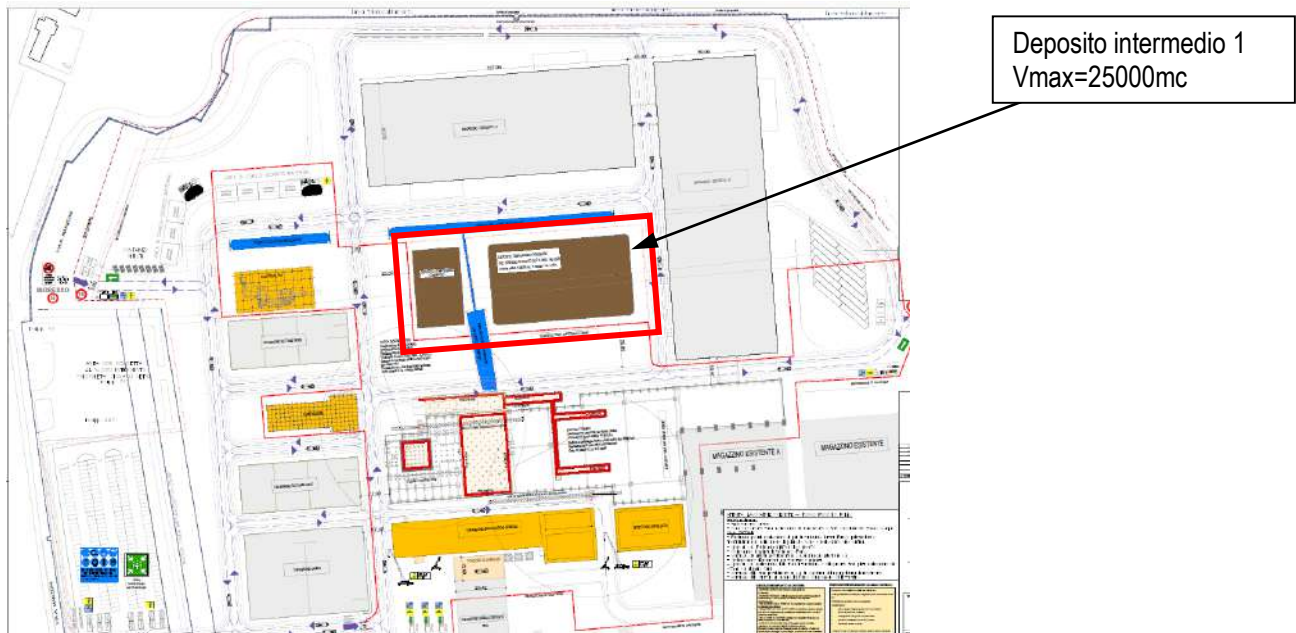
Deposito intermedio 1 – Zignago Vetro – Layout di cantiere
